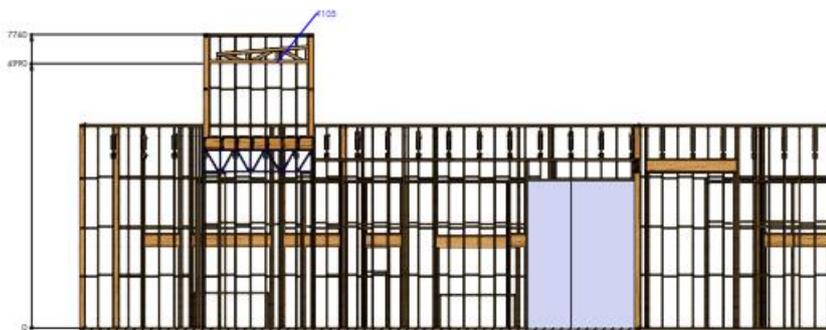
Projeto estrutural de *Wood Frame* da Construtora *Frame System*.
